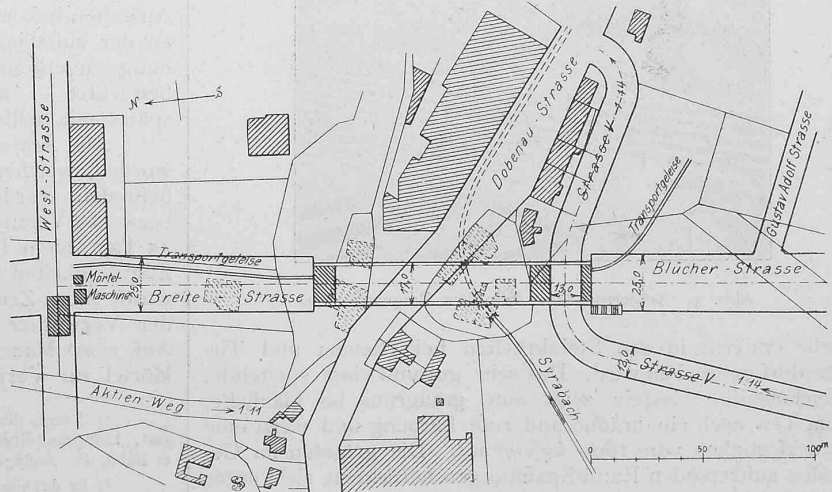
Lageplan der Umgebung der Brücke. — Masstab 1:3000.
